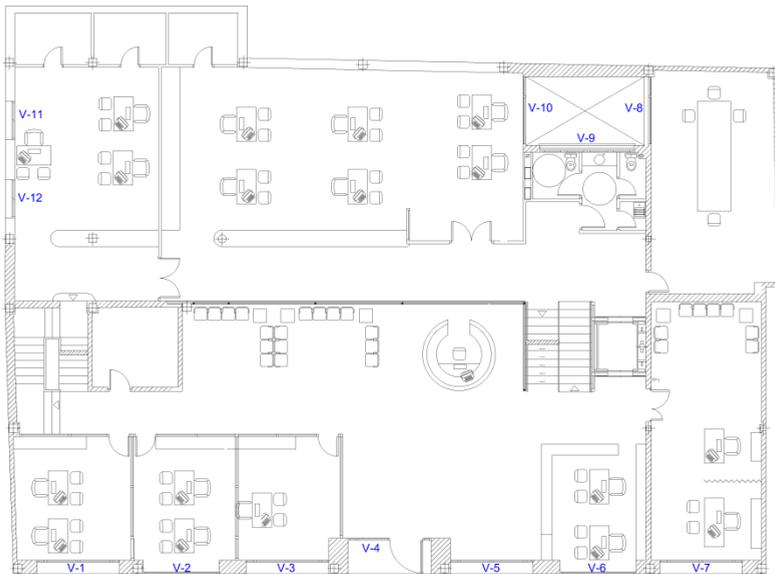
Distribución de huecos Planta Baja y Primera. 2002. AutoCAD.
